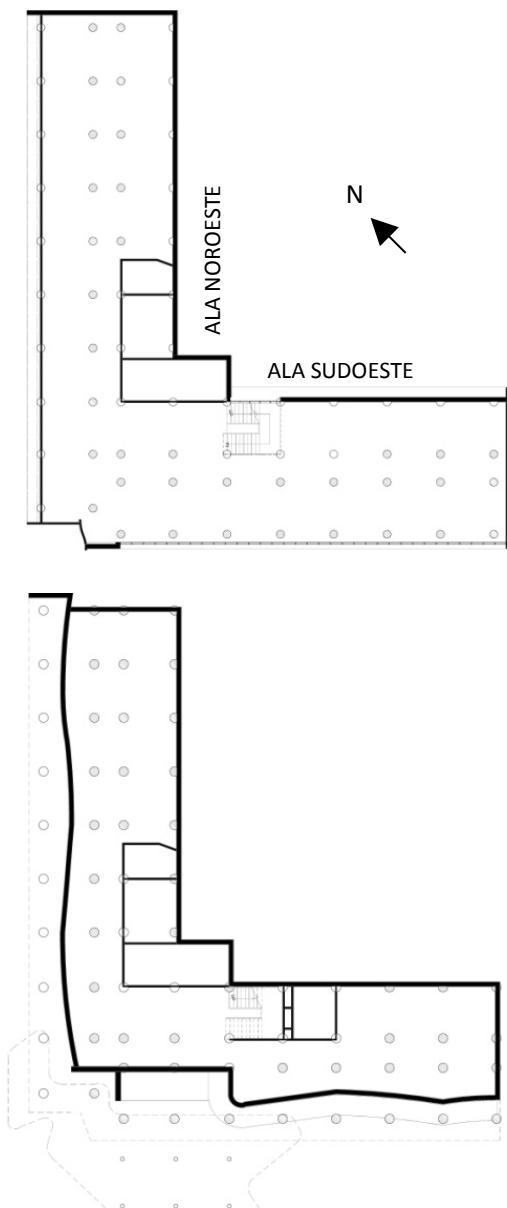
Planta baixa do pavimento tipo e térreo do Edifício das Diretorias.
